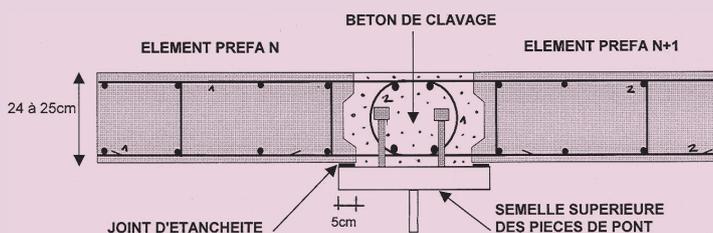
Principe de clavage sur semelles de pièces de pont
